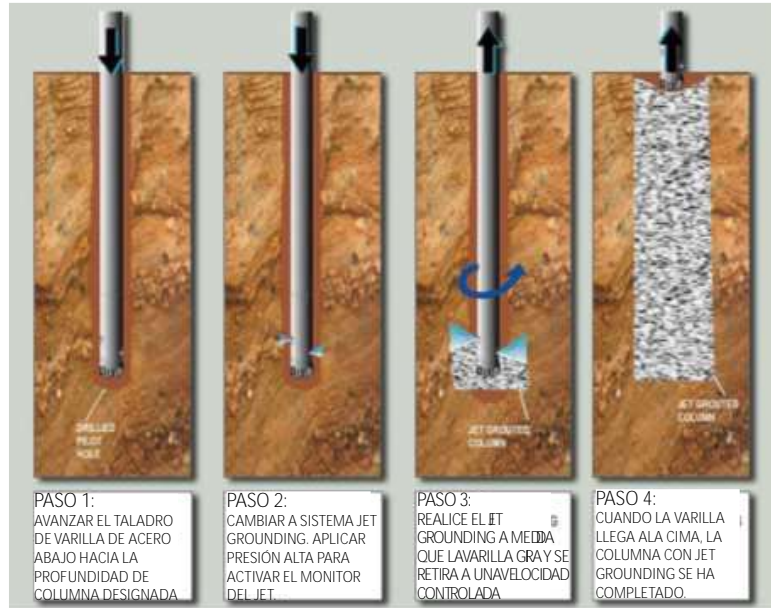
Esquema de perforación para tratamiento Jet – Grouting
